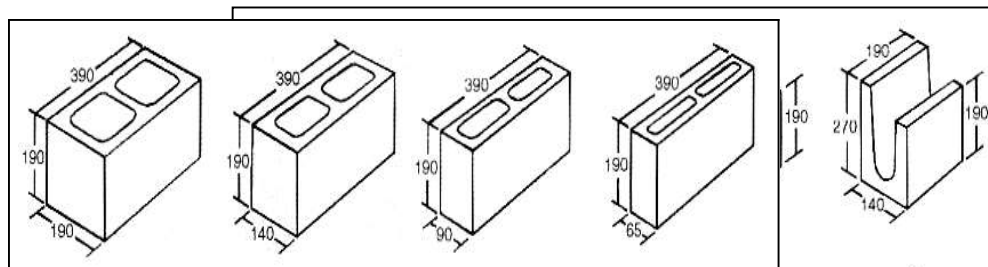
Blocos de concreto = padrões para paredes de várias espessuras.
